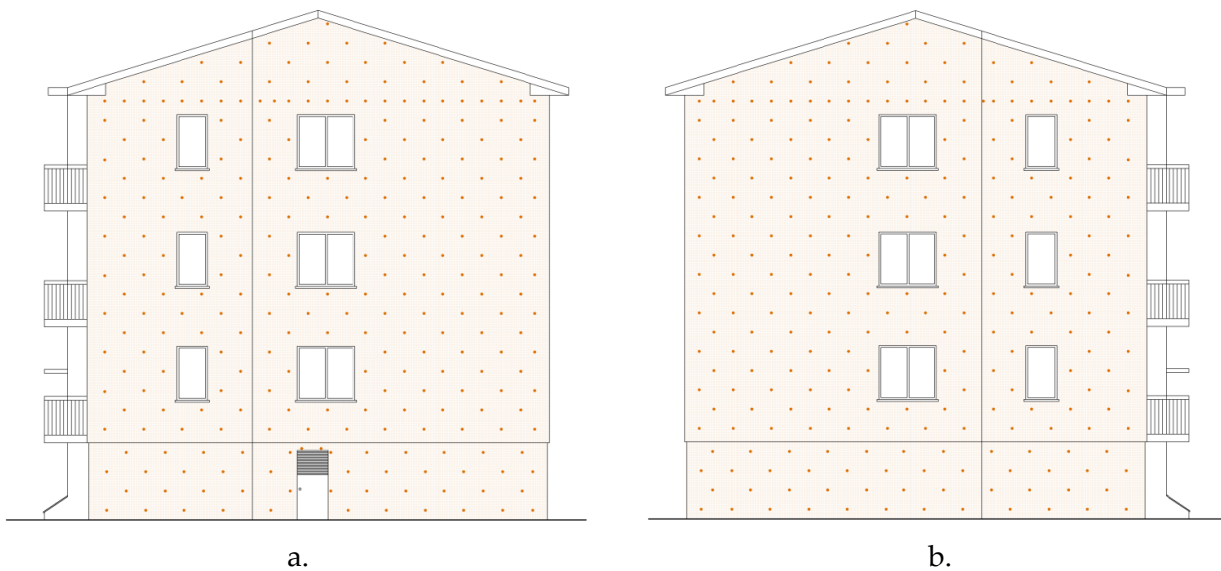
Intonaco armato con rete elettrosaldata su due lati: a) prospetto nord; b) prospetto sud.
